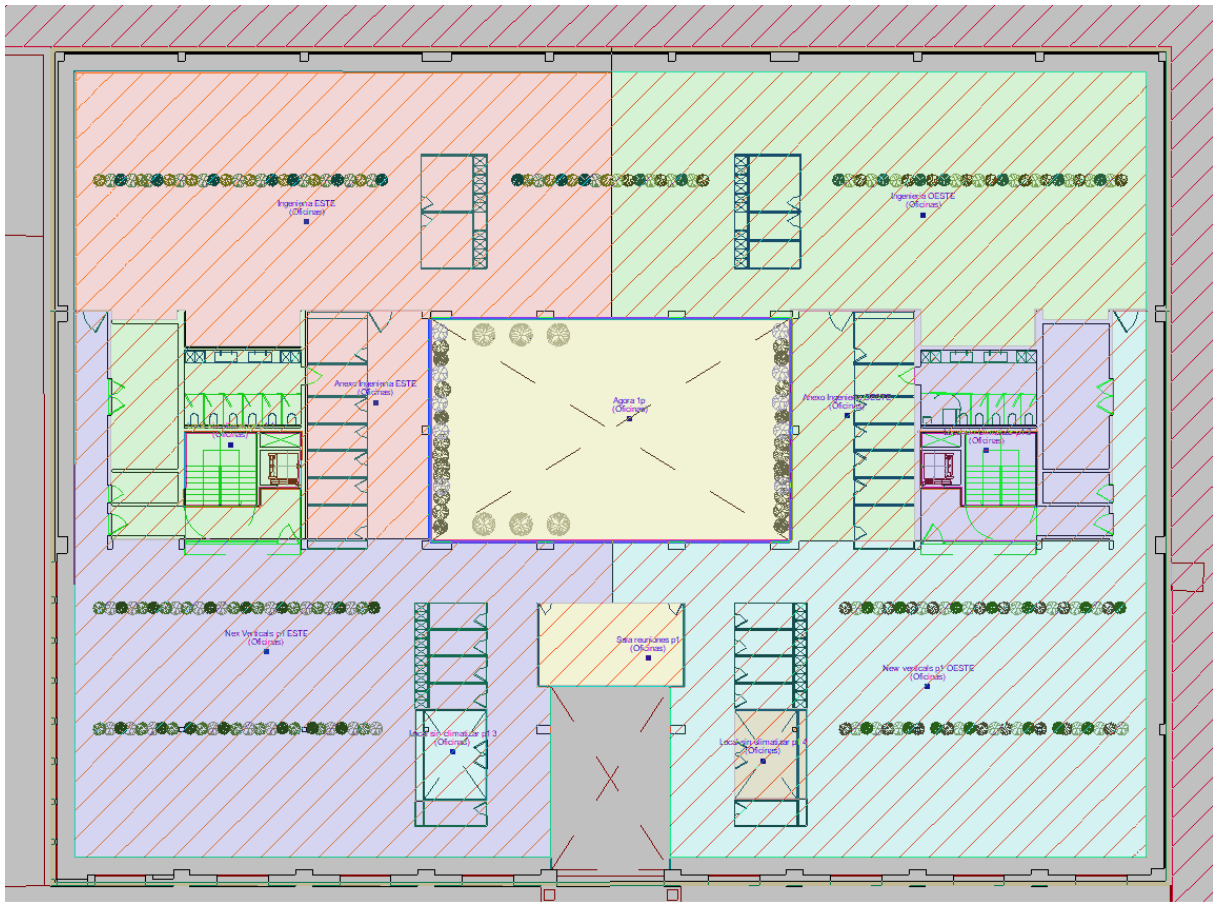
Figura con recintos en CYPE. Planta primera.
